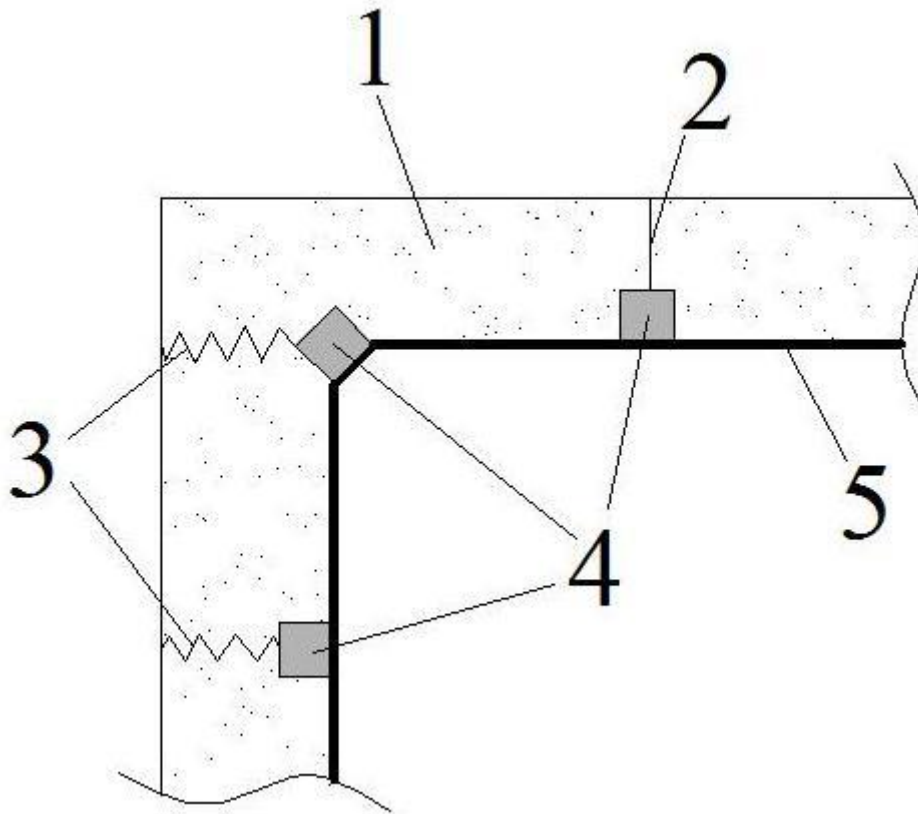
Гидроизоляция швов бетонирования, статических трещин и примыканий:
